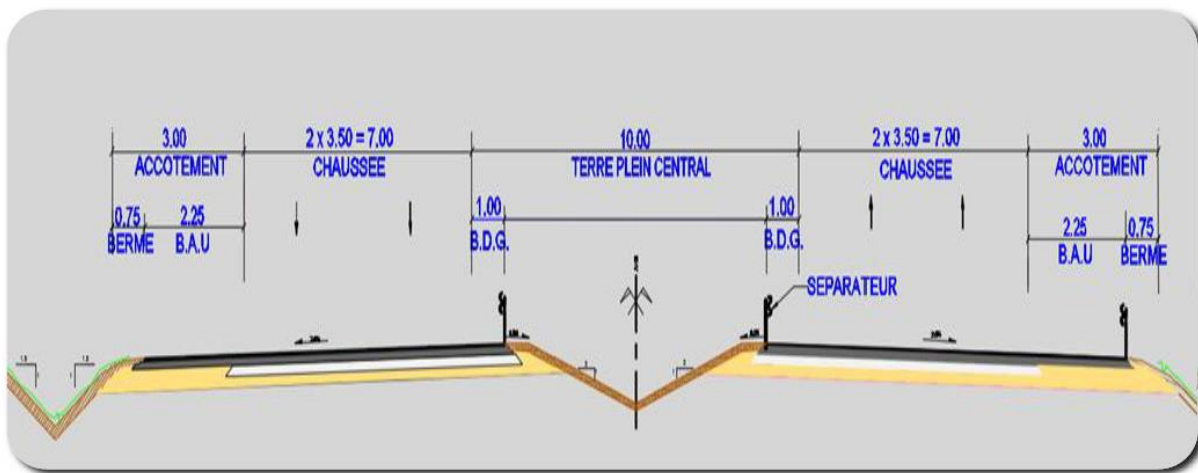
Schéma explicatif d'une Coupe transversale de la chaussée prévue.
